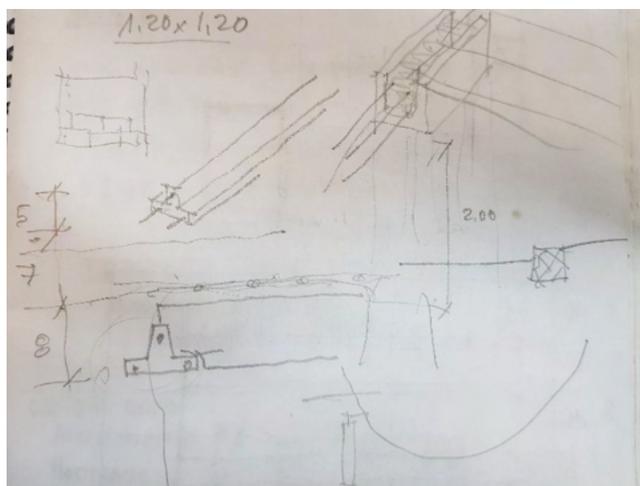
Croquis de explicitação construtiva do sistema de alvenaria armada.
